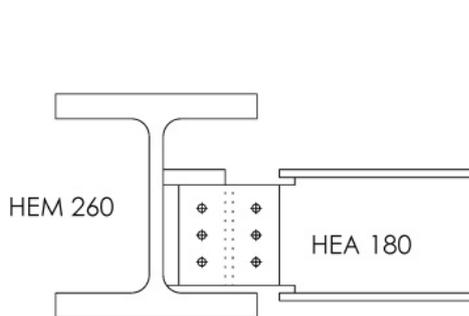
Detail B (M 1:10): Gelenkiger Anschluss Nebenträger an Hauptträger
